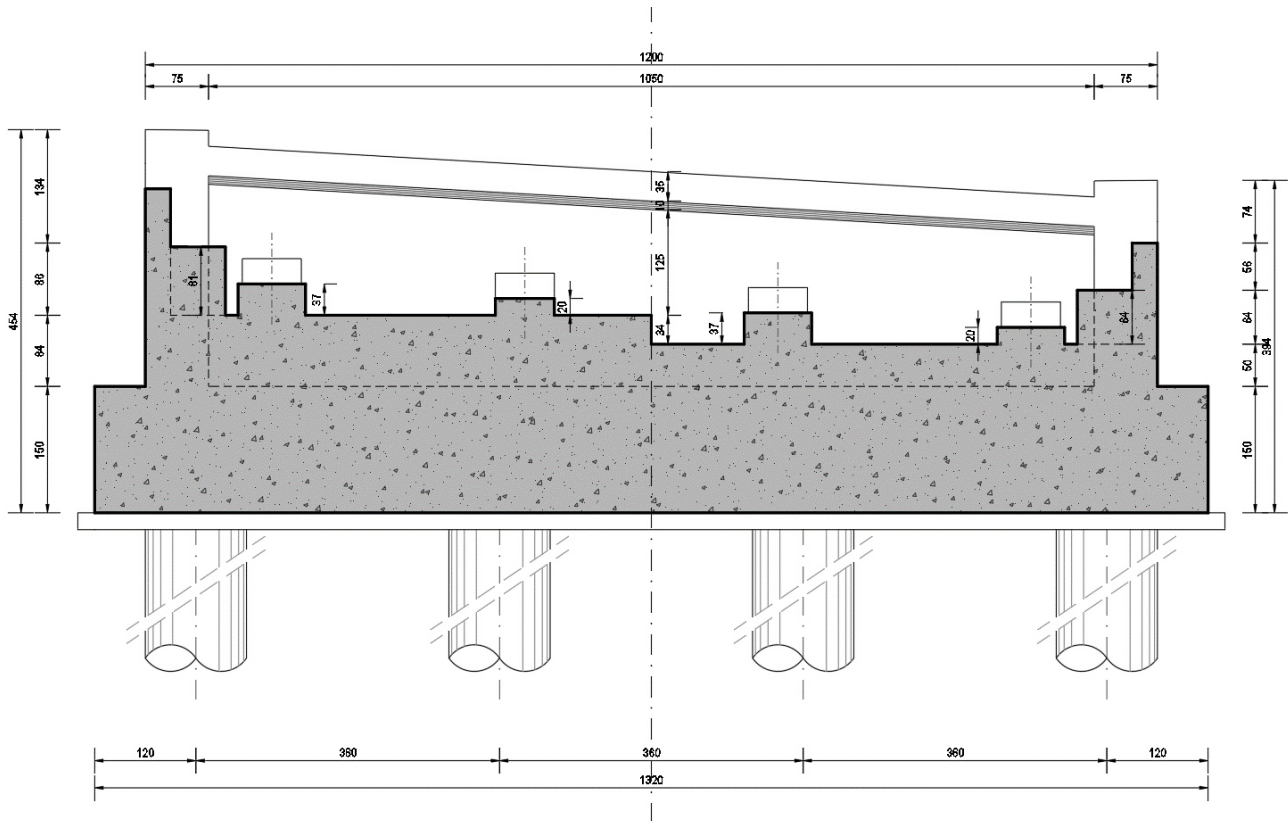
SEZIONE LONGITUDINALE SPALLA
